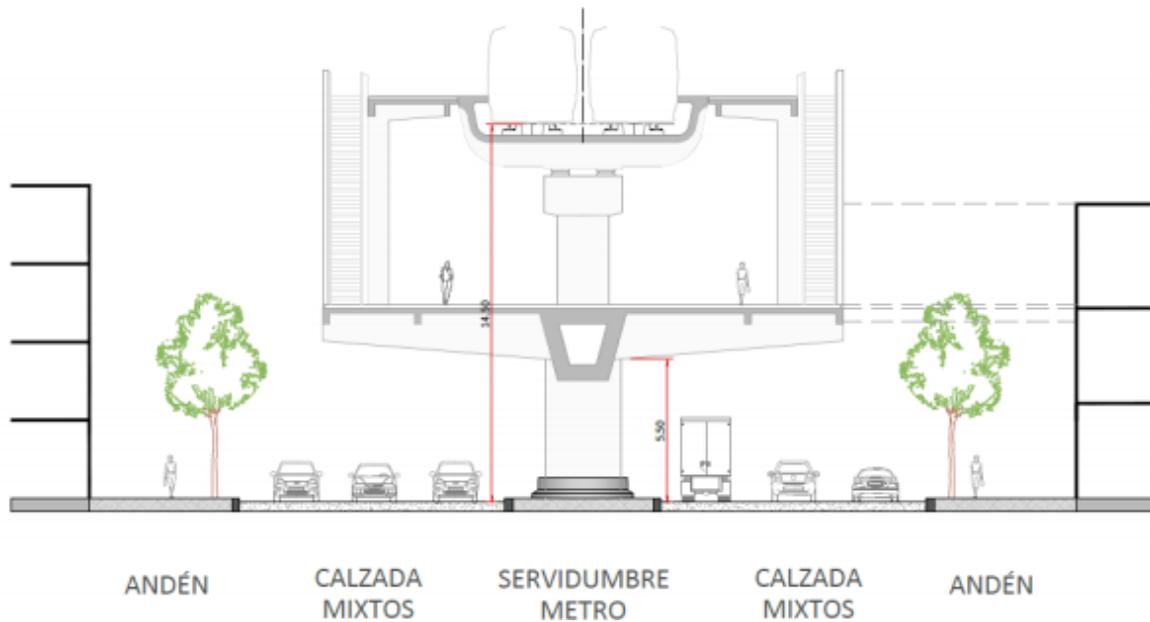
Sección tipo Av. Primero de Mayo con estación existente – Fuente: SYSTRA
